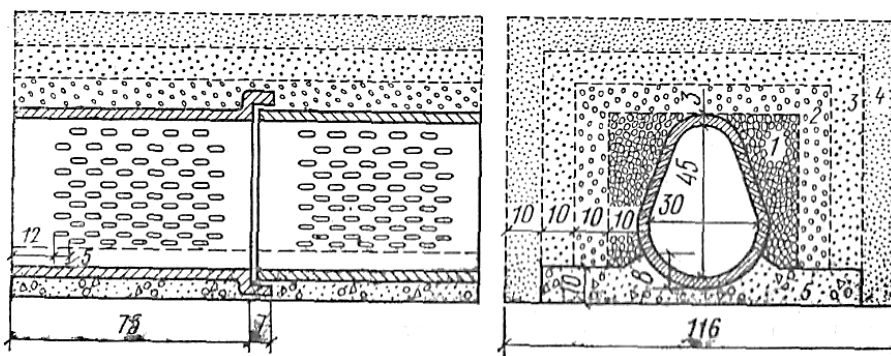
Горизонтальный водозабор из железобетонных труб овоидального сечения
